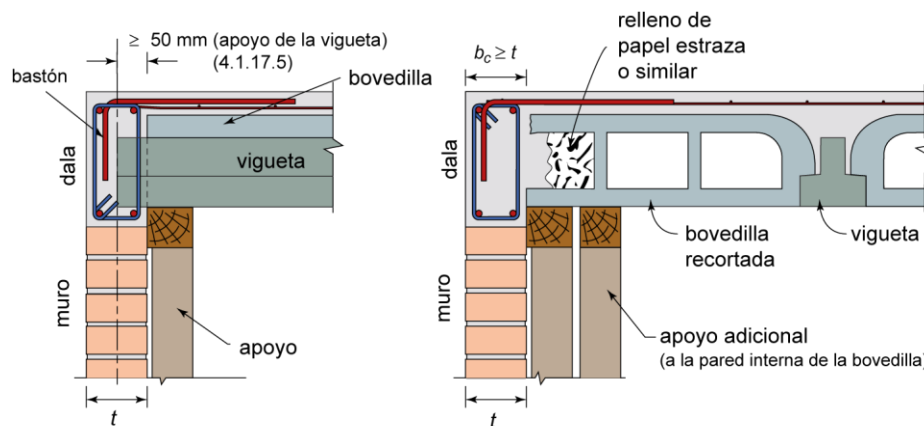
Apoyo de viguetas y bovedillas recortadas
